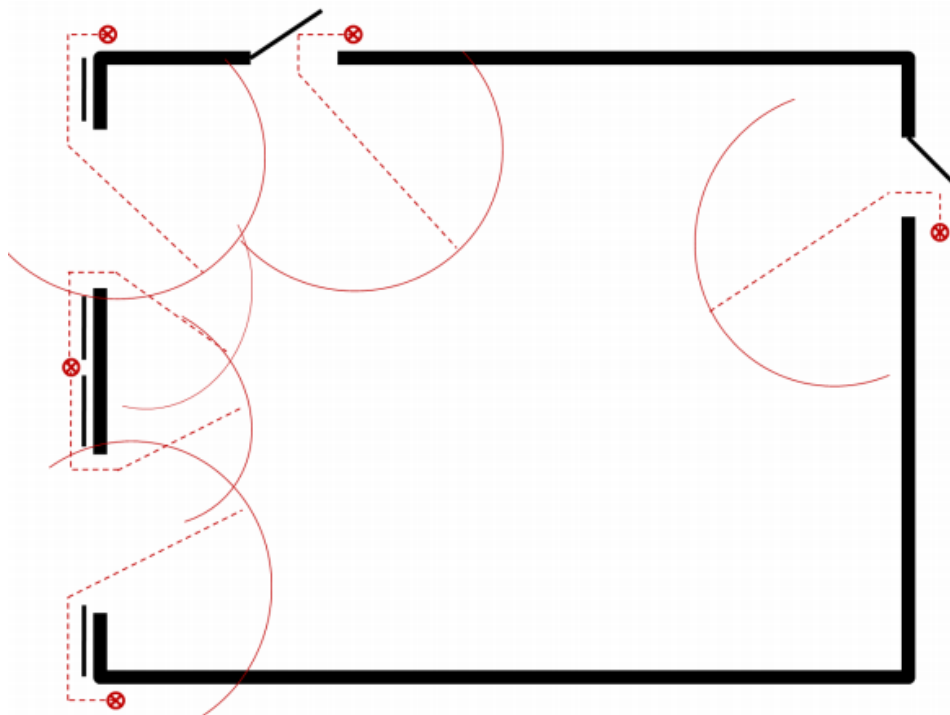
Esquema en planta del alcance de las mangueras hidrantes. Fuente: <http://www.redproteger.com.ar>
